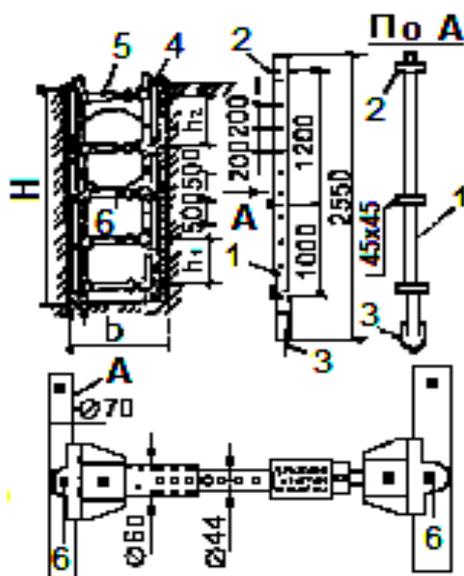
Сплошное вертикальное крепление стенок траншеи для укладки ПВТНК из ВЧШГ
